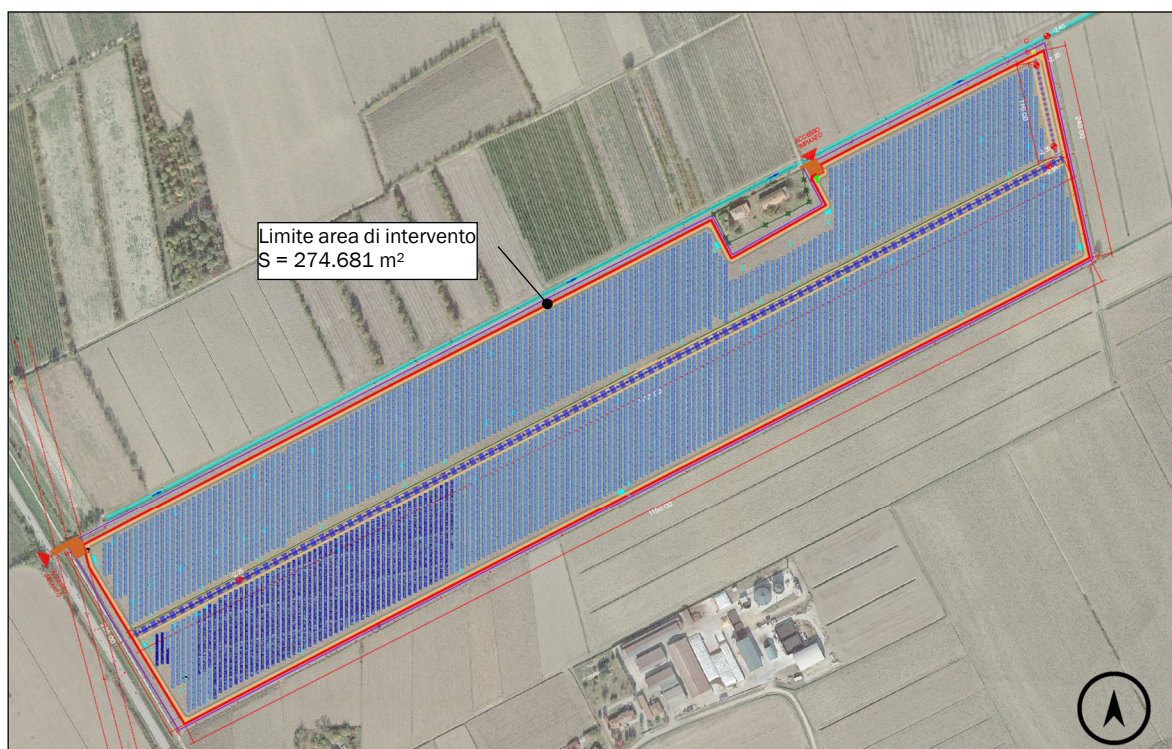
Lotto oggetto dell'intervento allo stato di progetto
